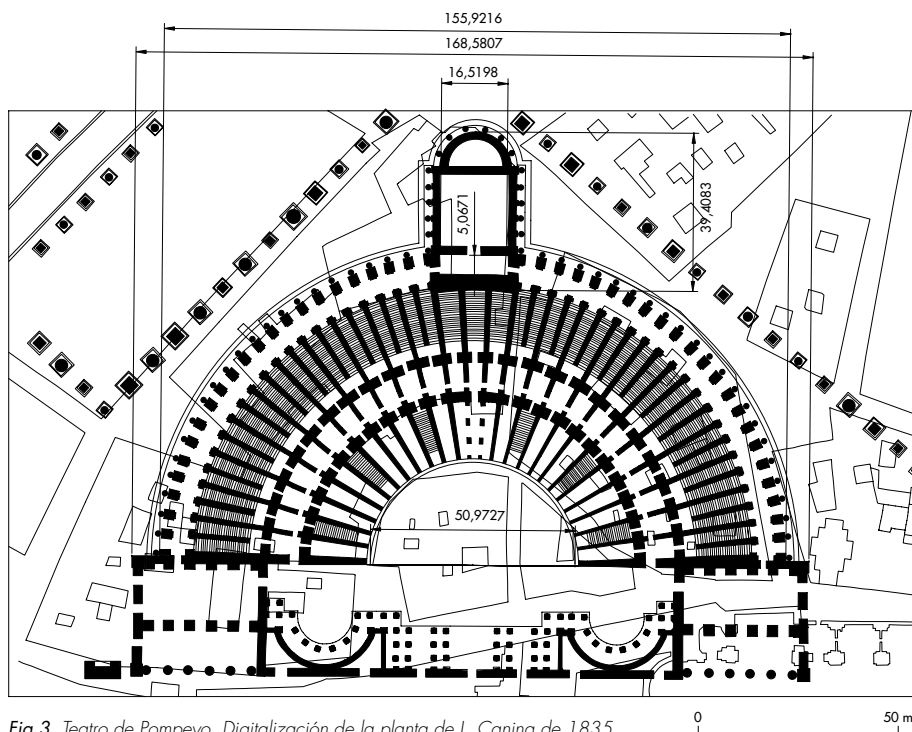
Teatro de Pompeyo. Digitalización de la planta de L. Canina de 1835.
